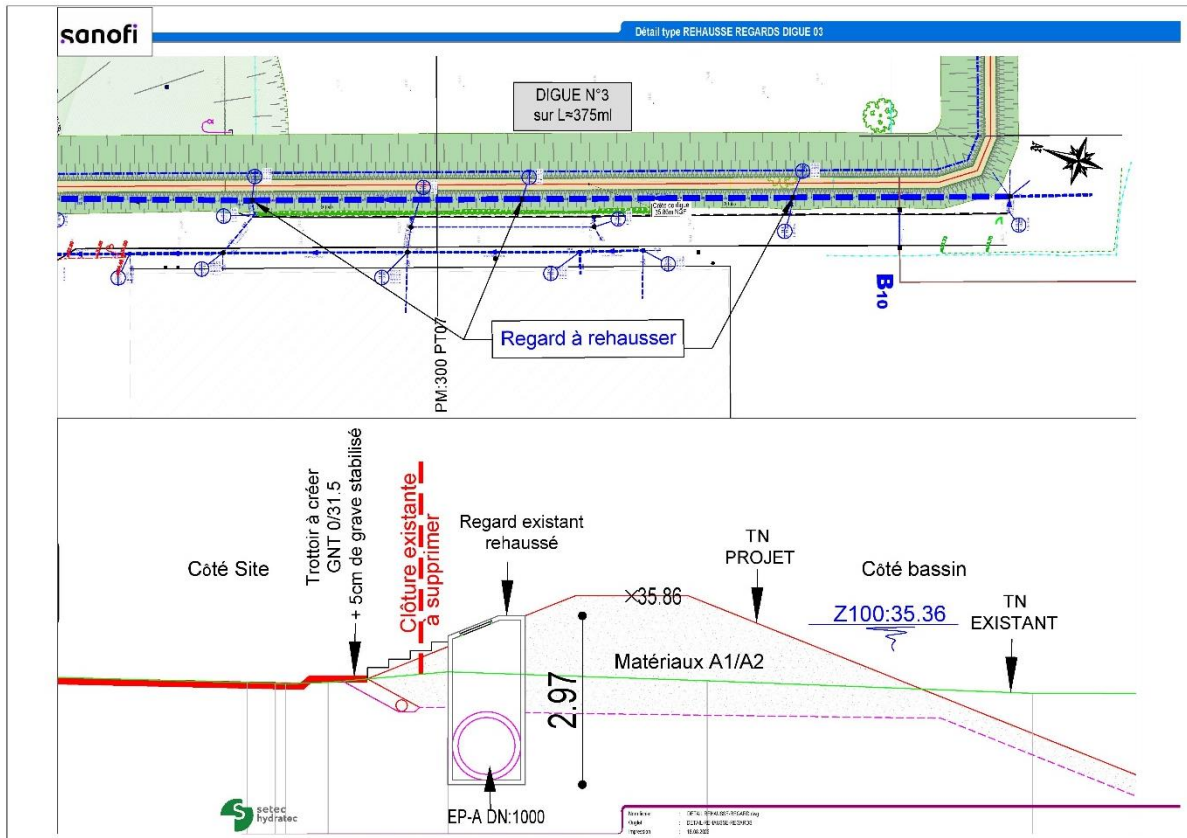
Rehaussement des tampons de la conduite 1000 mm en pied de la digue 3
